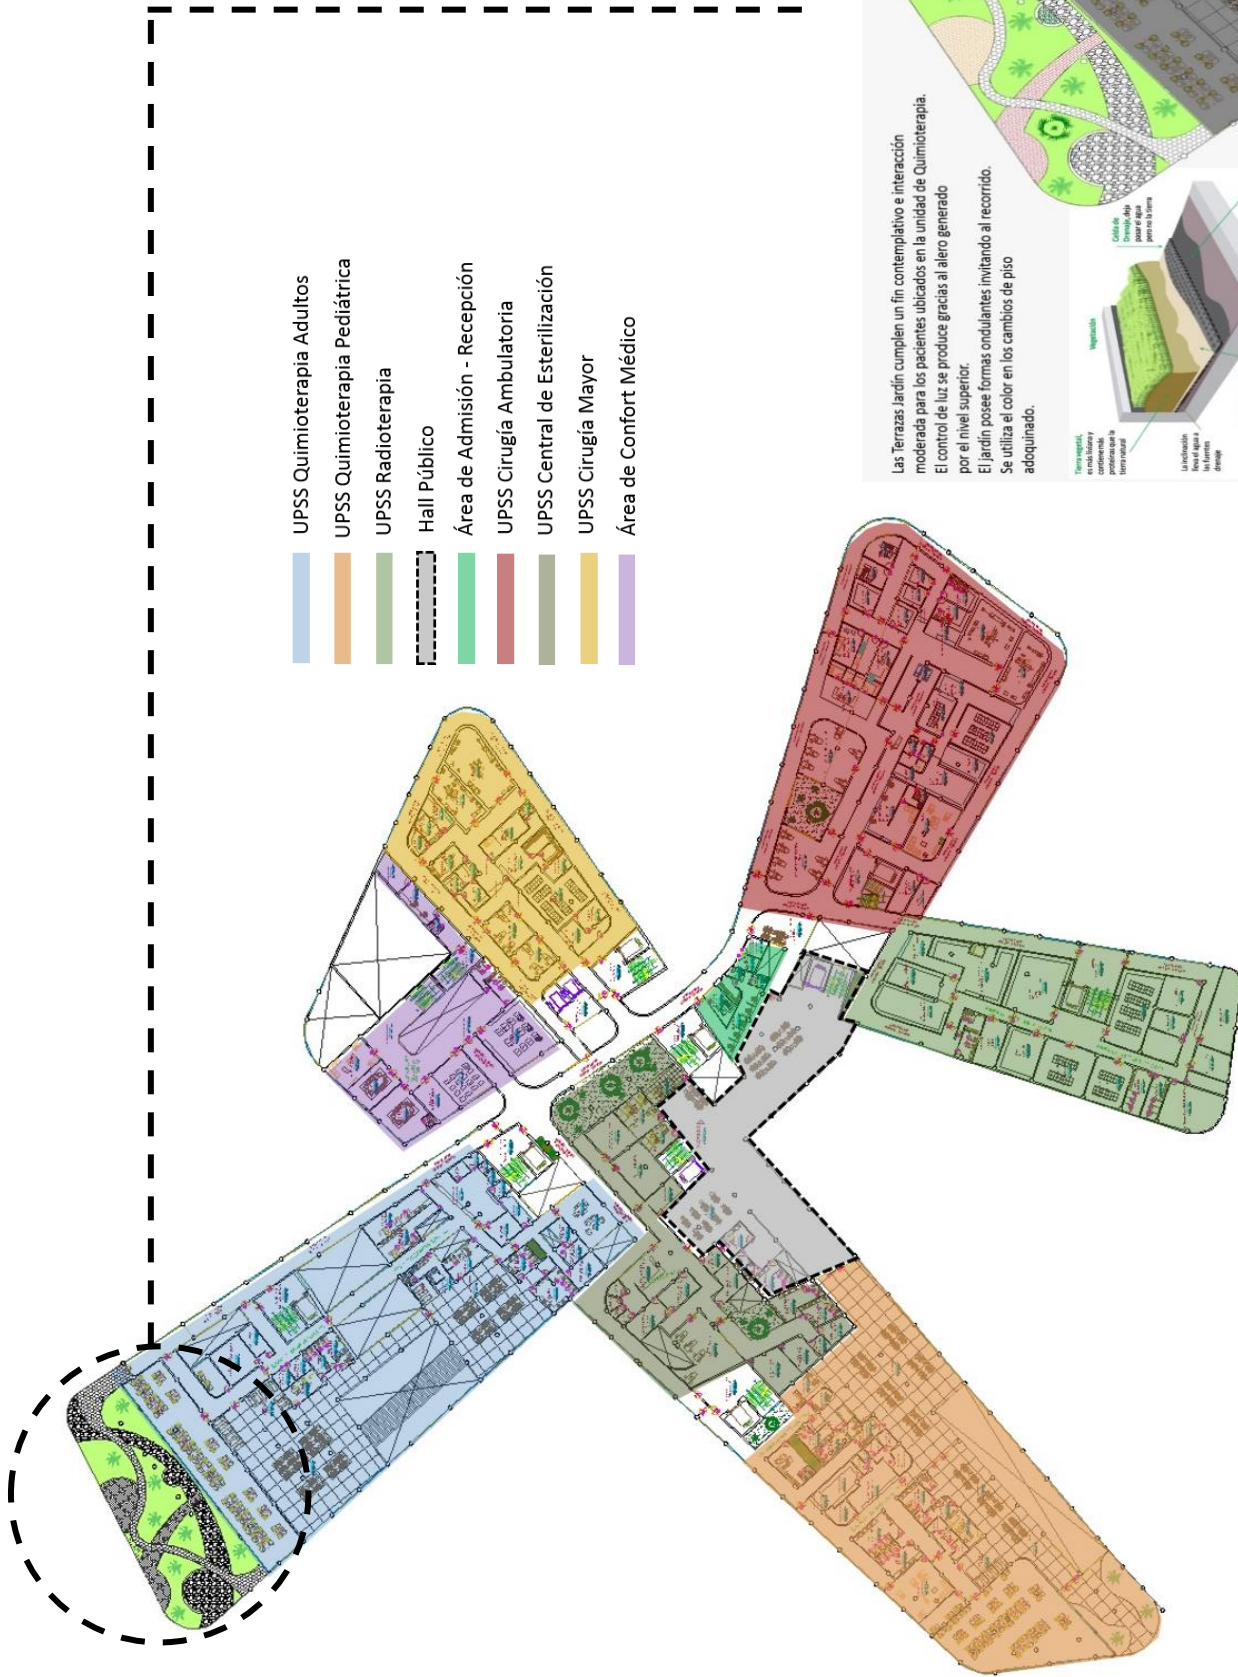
Zonificación Segunda Planta de la Propuesta Arquitectónica.
